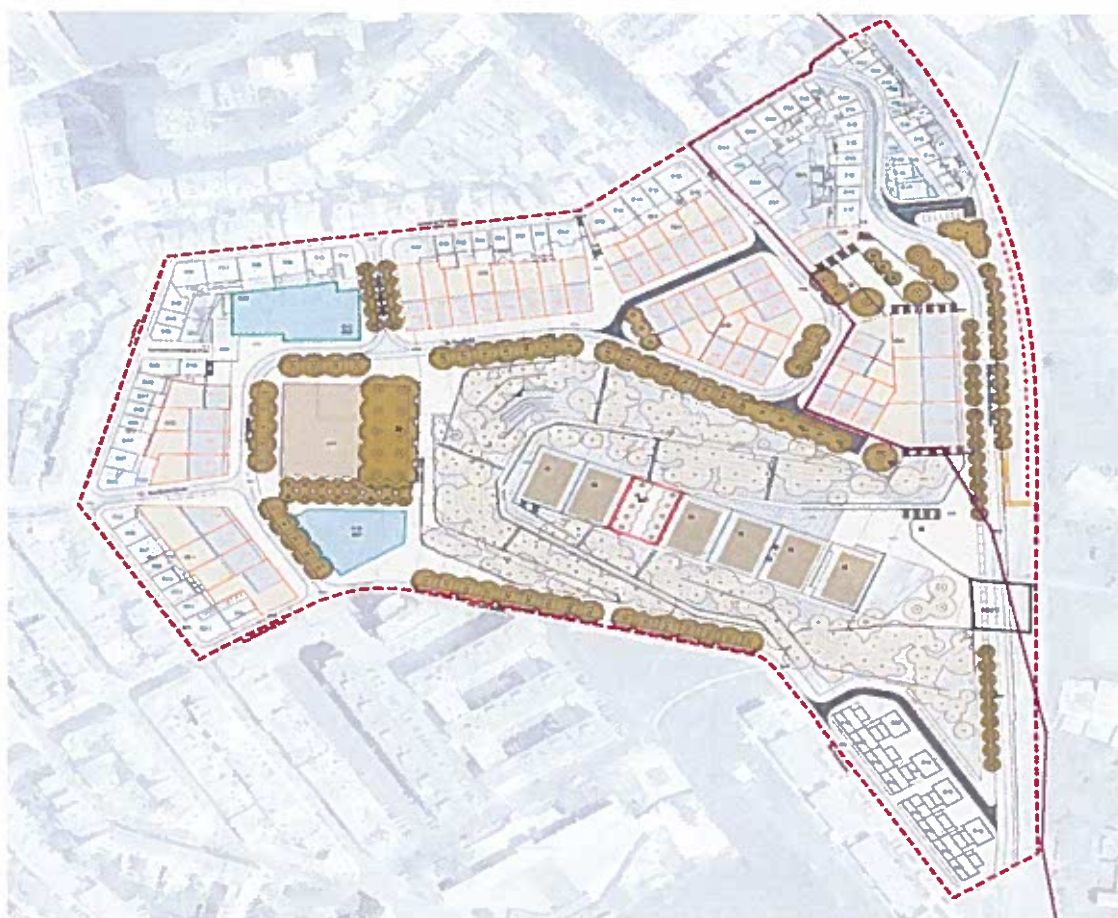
Planta de implantação do Plano de Pormenor do Casal do Pinto.
